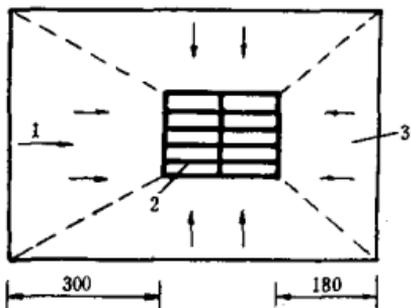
中央分隔带格栅式泄水口布置示意(尺寸单位:cm)
